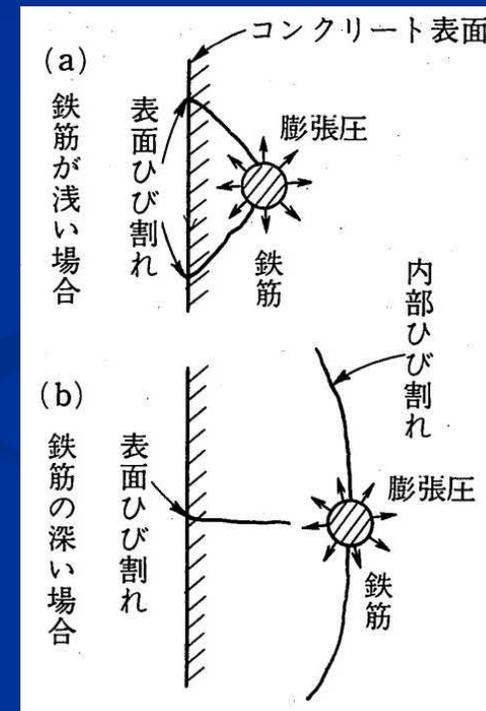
鉄筋腐食の膨張圧によるひび割れ
